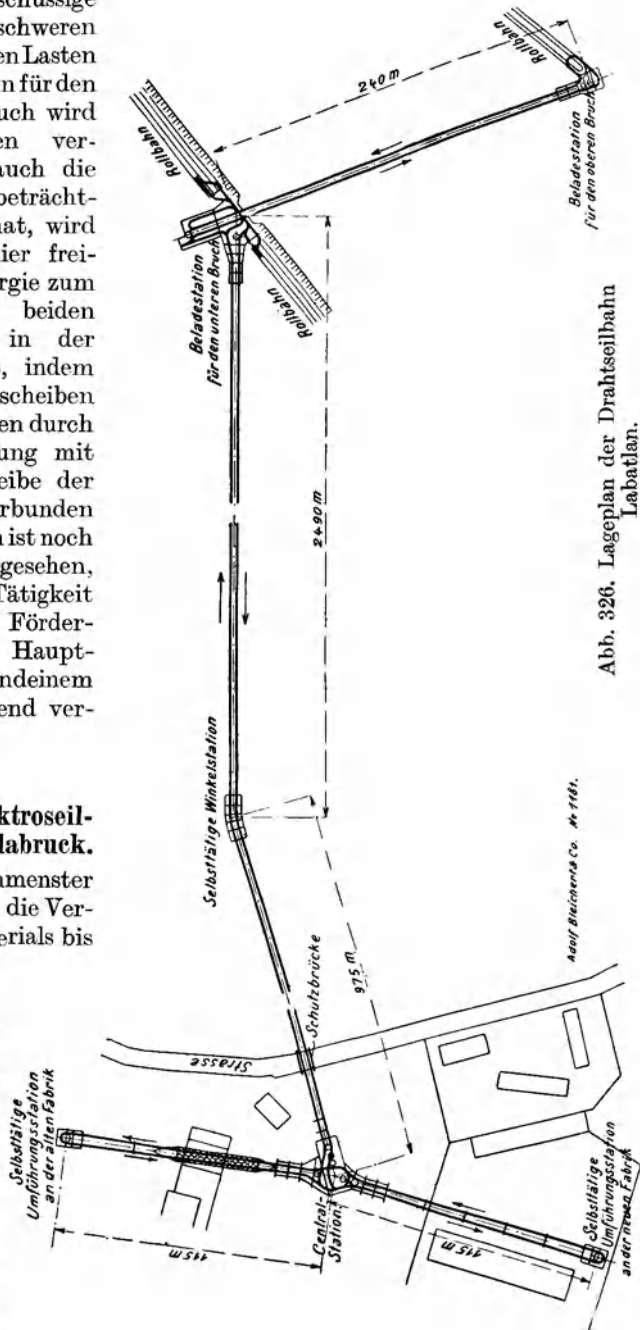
Lageplan der Drahtseilbahn Labatlan.
